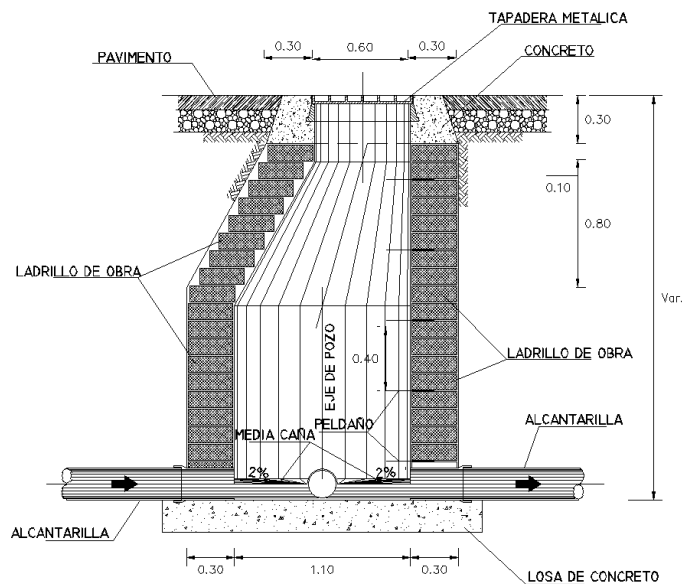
Perfil de pozo de visita simple de mampostería [Fuente: Plano tipo de ANDA].
